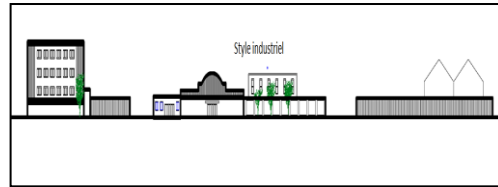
Façade sur boulevard Rouchai Boualem(sud)
